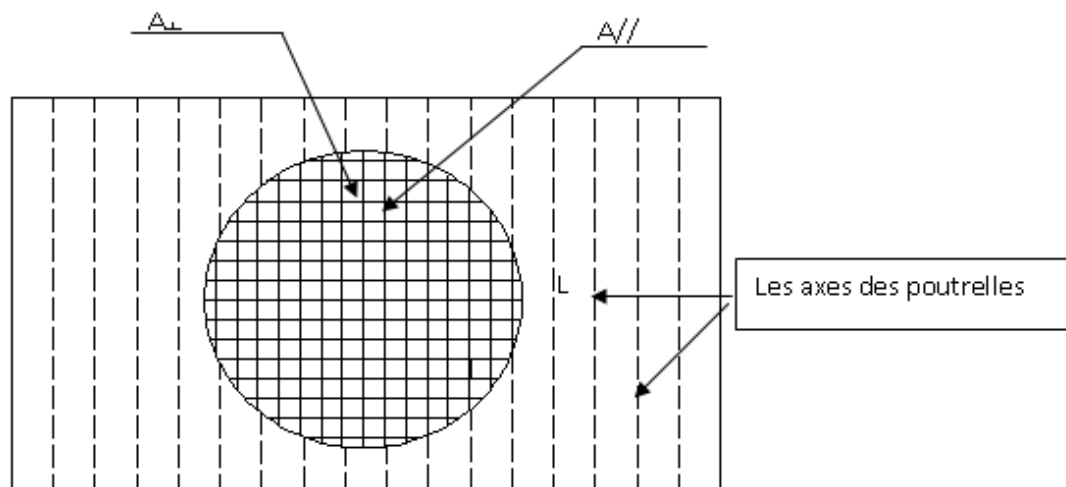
Schéma de Ferrailage de la dalle de compression.
